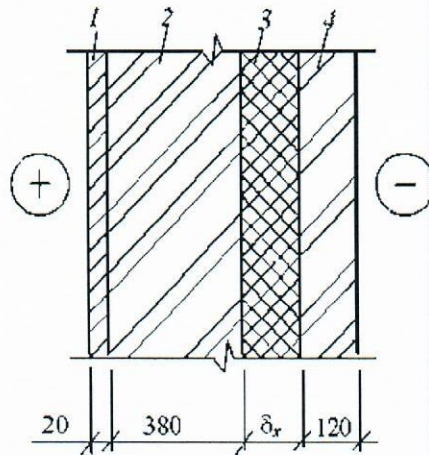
Вариант 1-й конструкции наружной стены:
